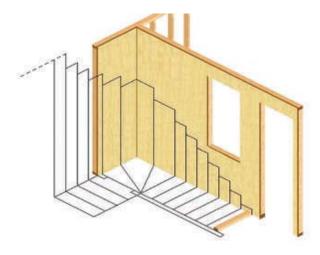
26: Trazado de la proyección horizontal y vertical de la escalera y ubicación de la pieza de anclaje (madera o conector metálico), para la fijación de apoyo de los largueros.
